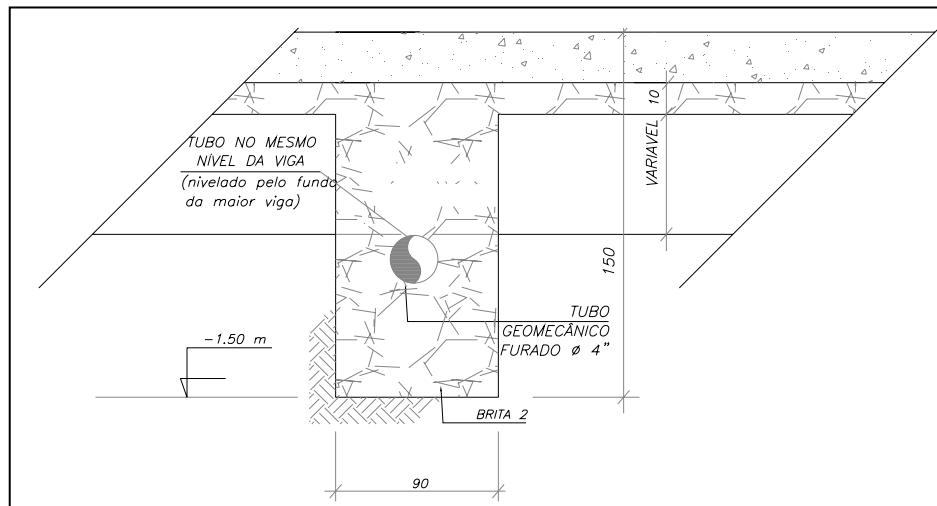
Detalhe do dreno horizontal (trincheira)
